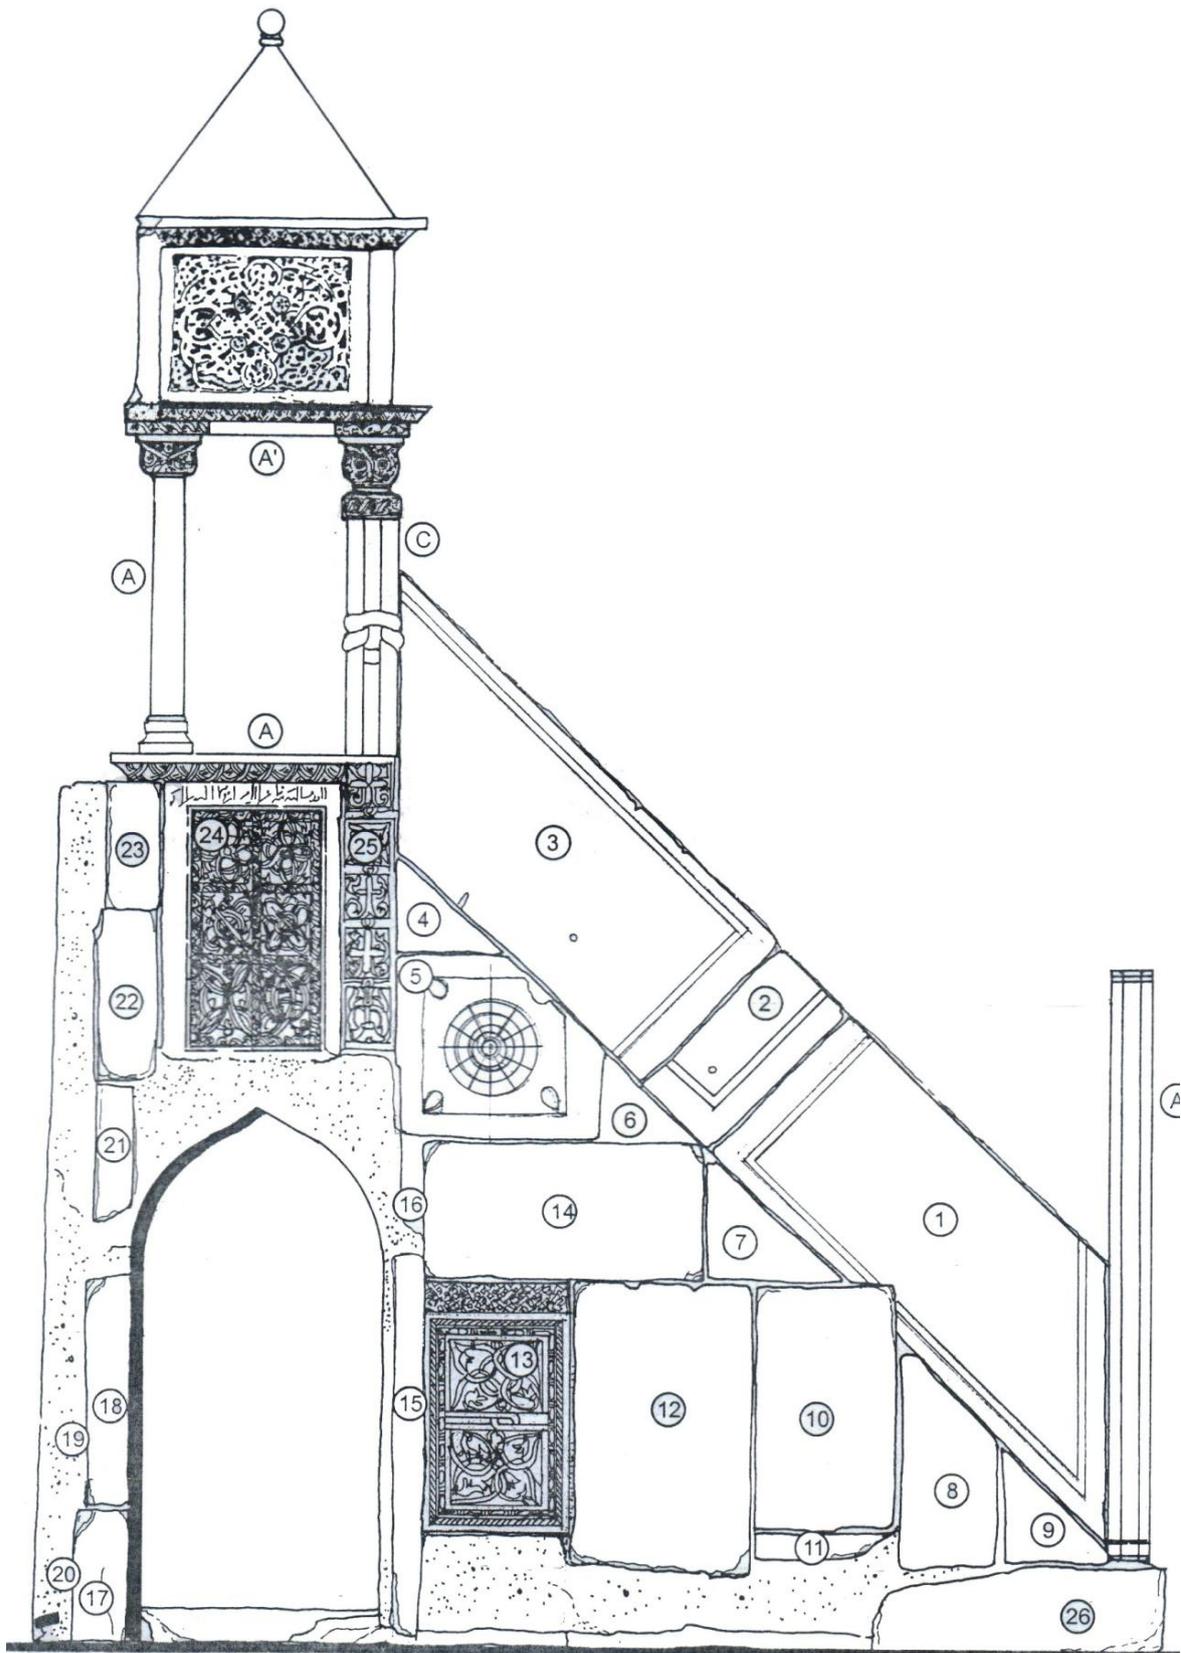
Alzado este del mimbar turco de Santa Sofia.
